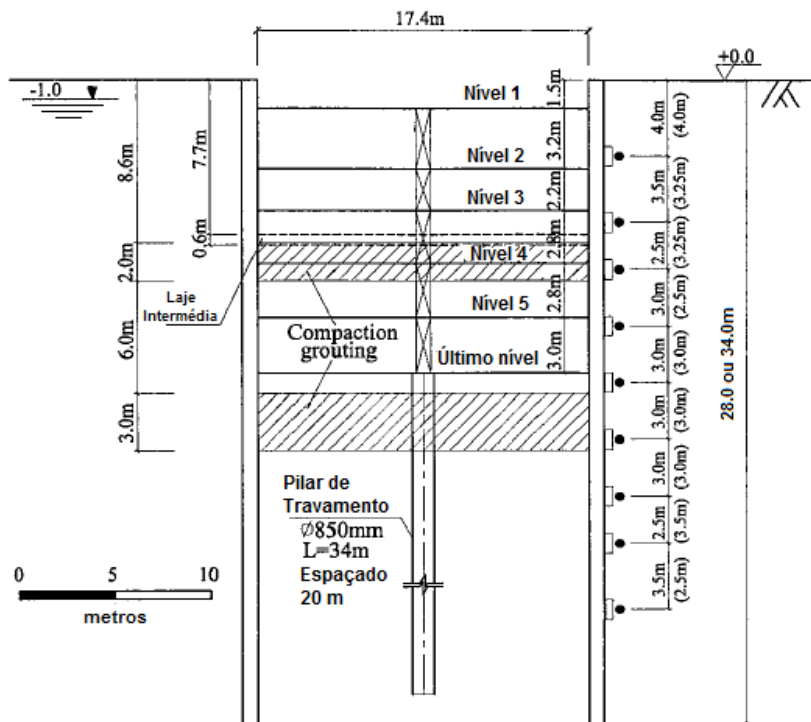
Secção transversal da escavação (adaptado de Liu *et al.*, 2005).
